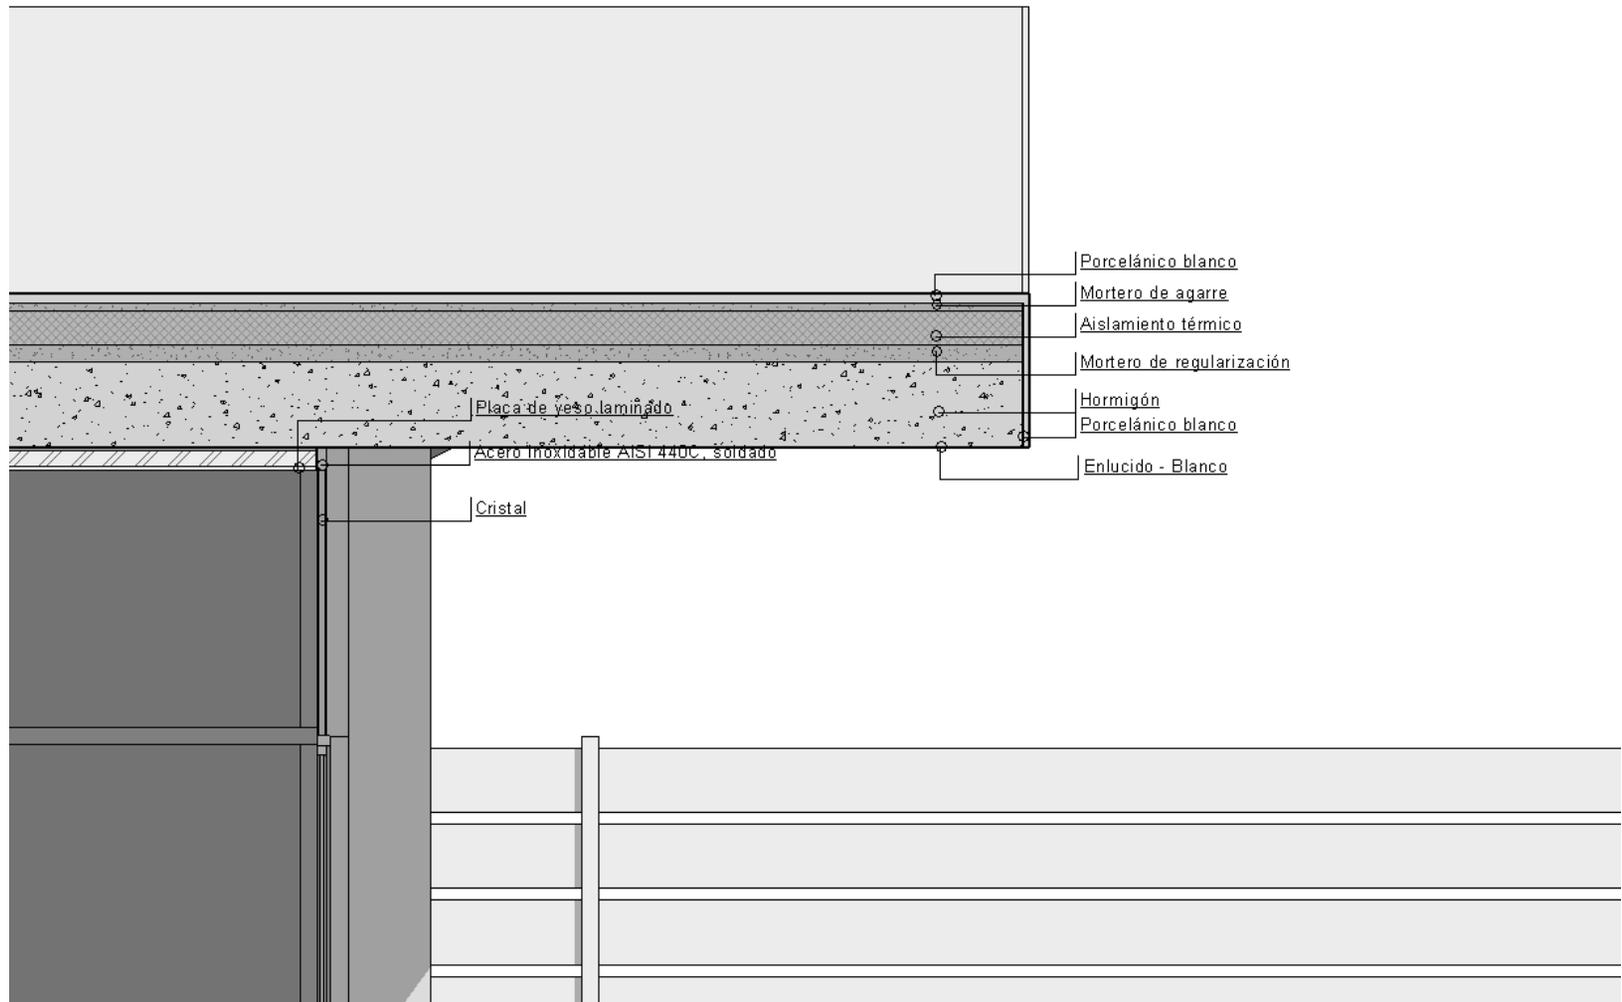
Detalle cubierta y ventana. Fuente: Elaboración propia.
